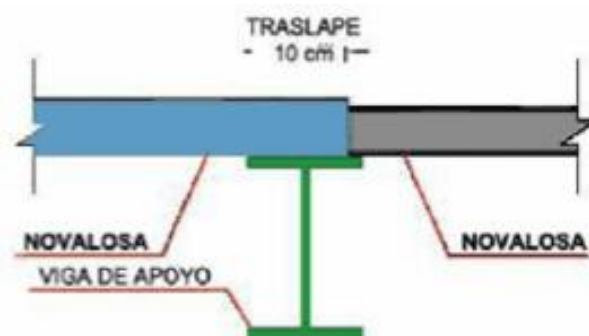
Detalle traslape placa NOVALOSA
